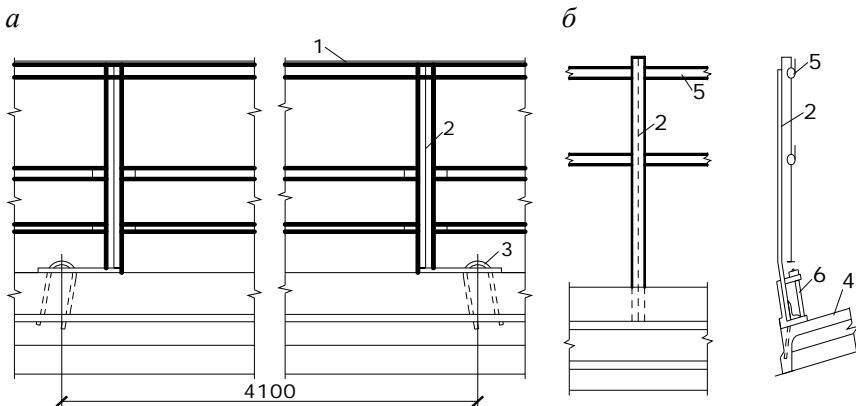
Временное ограждение по плитам покрытия (перекрытия):
